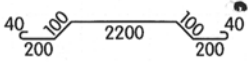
Przykładowy rysunek słupa żelbetowego [opracowanie własne]
